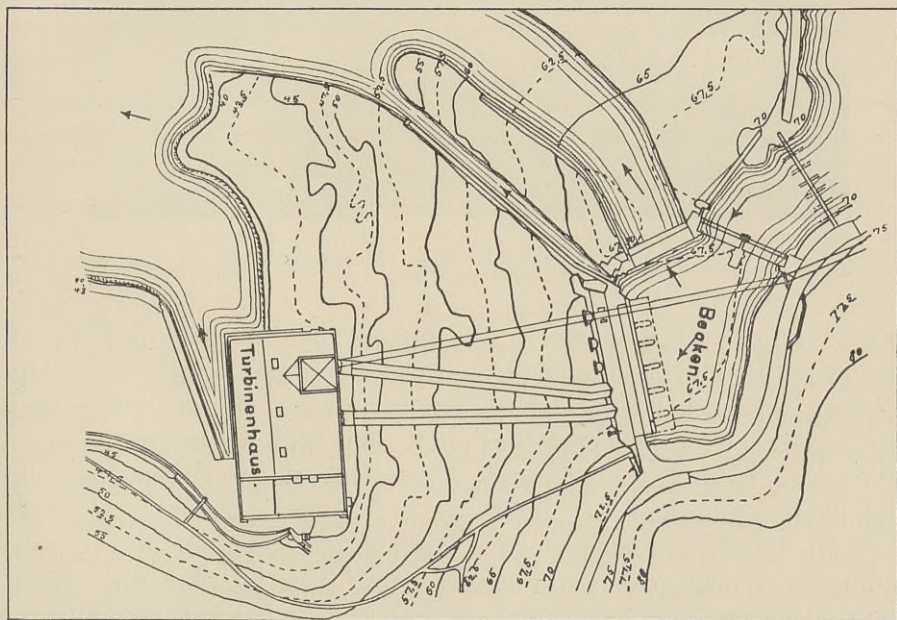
Oberer Lerfos. Lageplan. Maßstab 1:1500.
